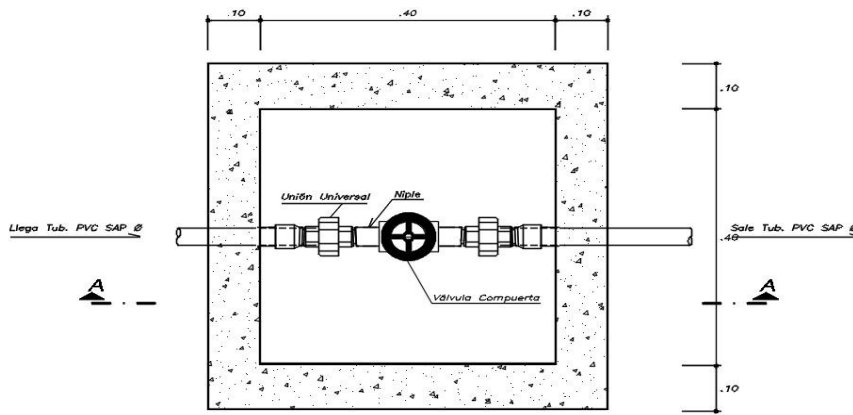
Detalles vista de corte transversal de Válvula de Purga Tipo II (CAD)
